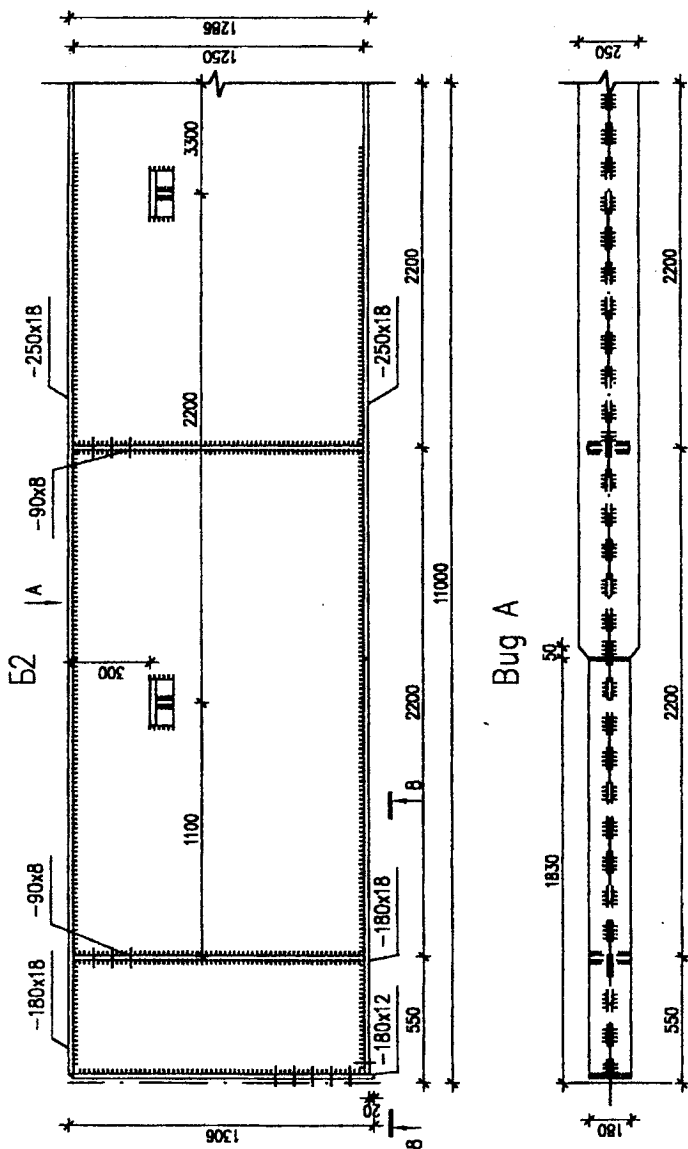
Фрагмент креслення на стадії КМ головної балки Б2
